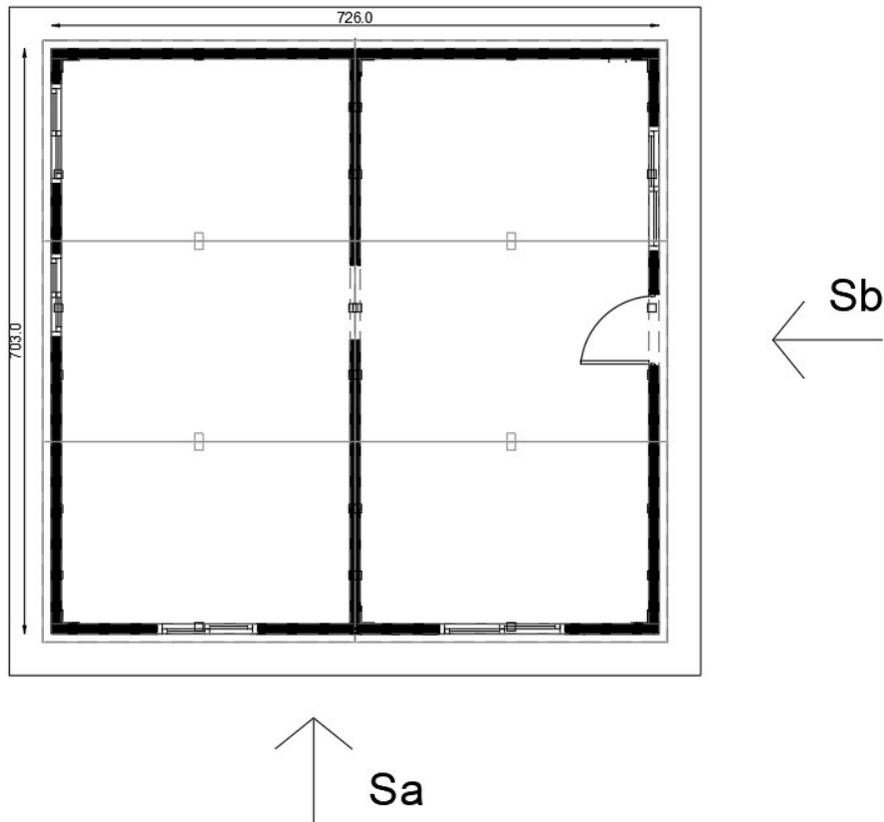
Planta tipo de estructura. Los muros expresados en sección llena están dispuestos ortogonalmente para transmitir las cargas gravitatorias de forma estable.
